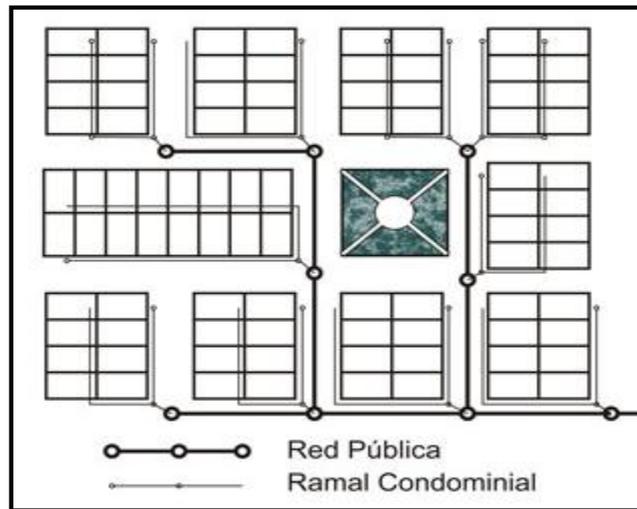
Sistema de alcantarillado simplificado. Fuente:
